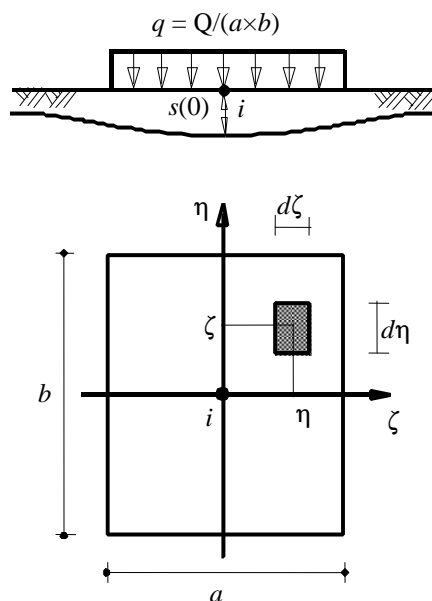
Gleichmäßig belastete Teilfläche auf dem isotropen Halbraum-Baugrund
